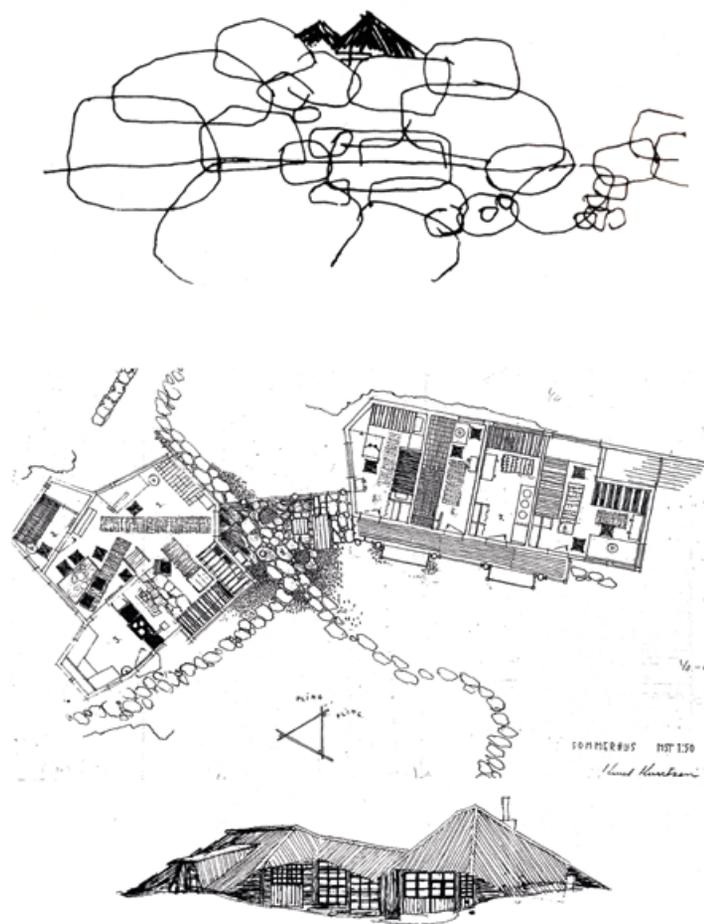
Knut Knutsen. Casa en Portor, 1949. Croquis, planta y alzado.
